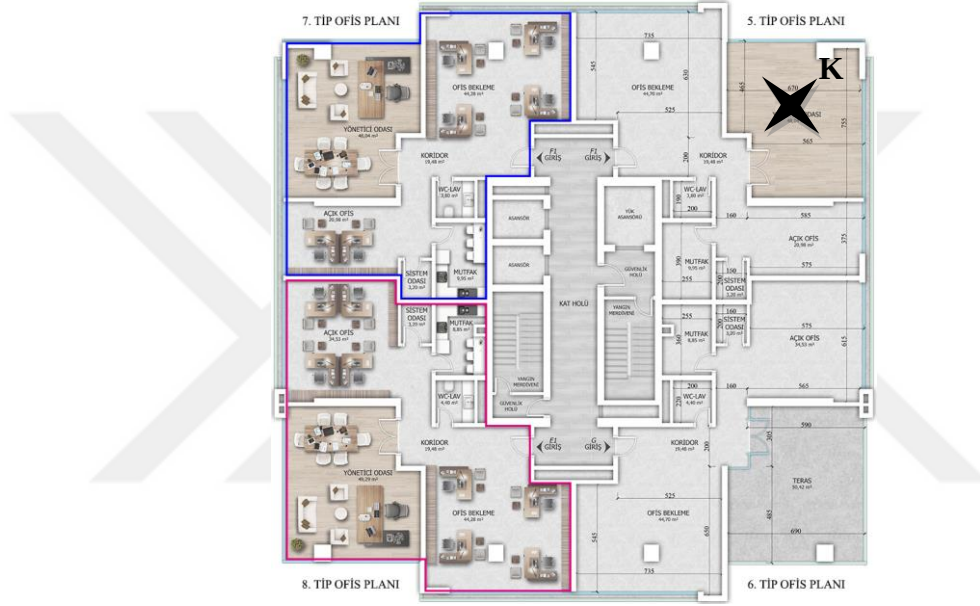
Kentplaza Ofis kat planı 13. kat planı ve 14. kat planı (URL-17)
